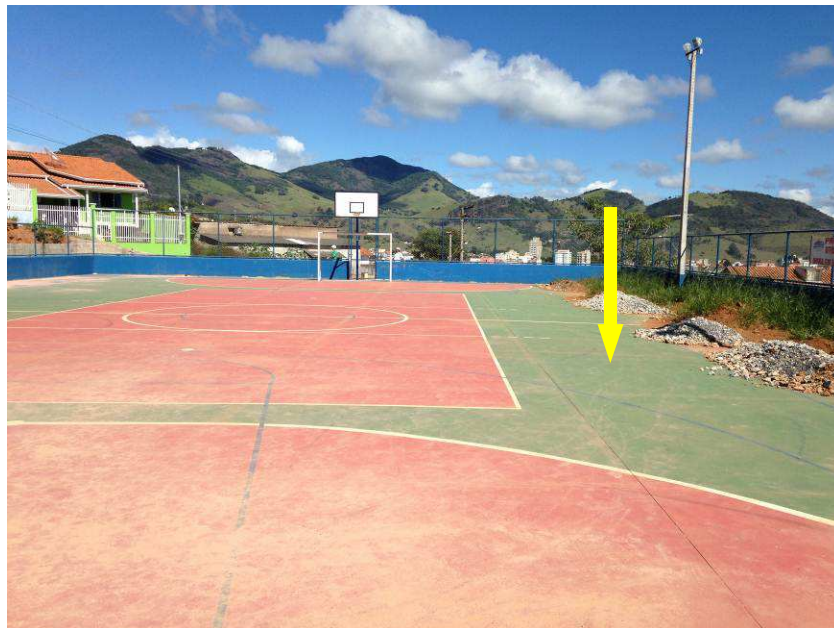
Inclinação do piso na porção junto a borda superior do muro.
